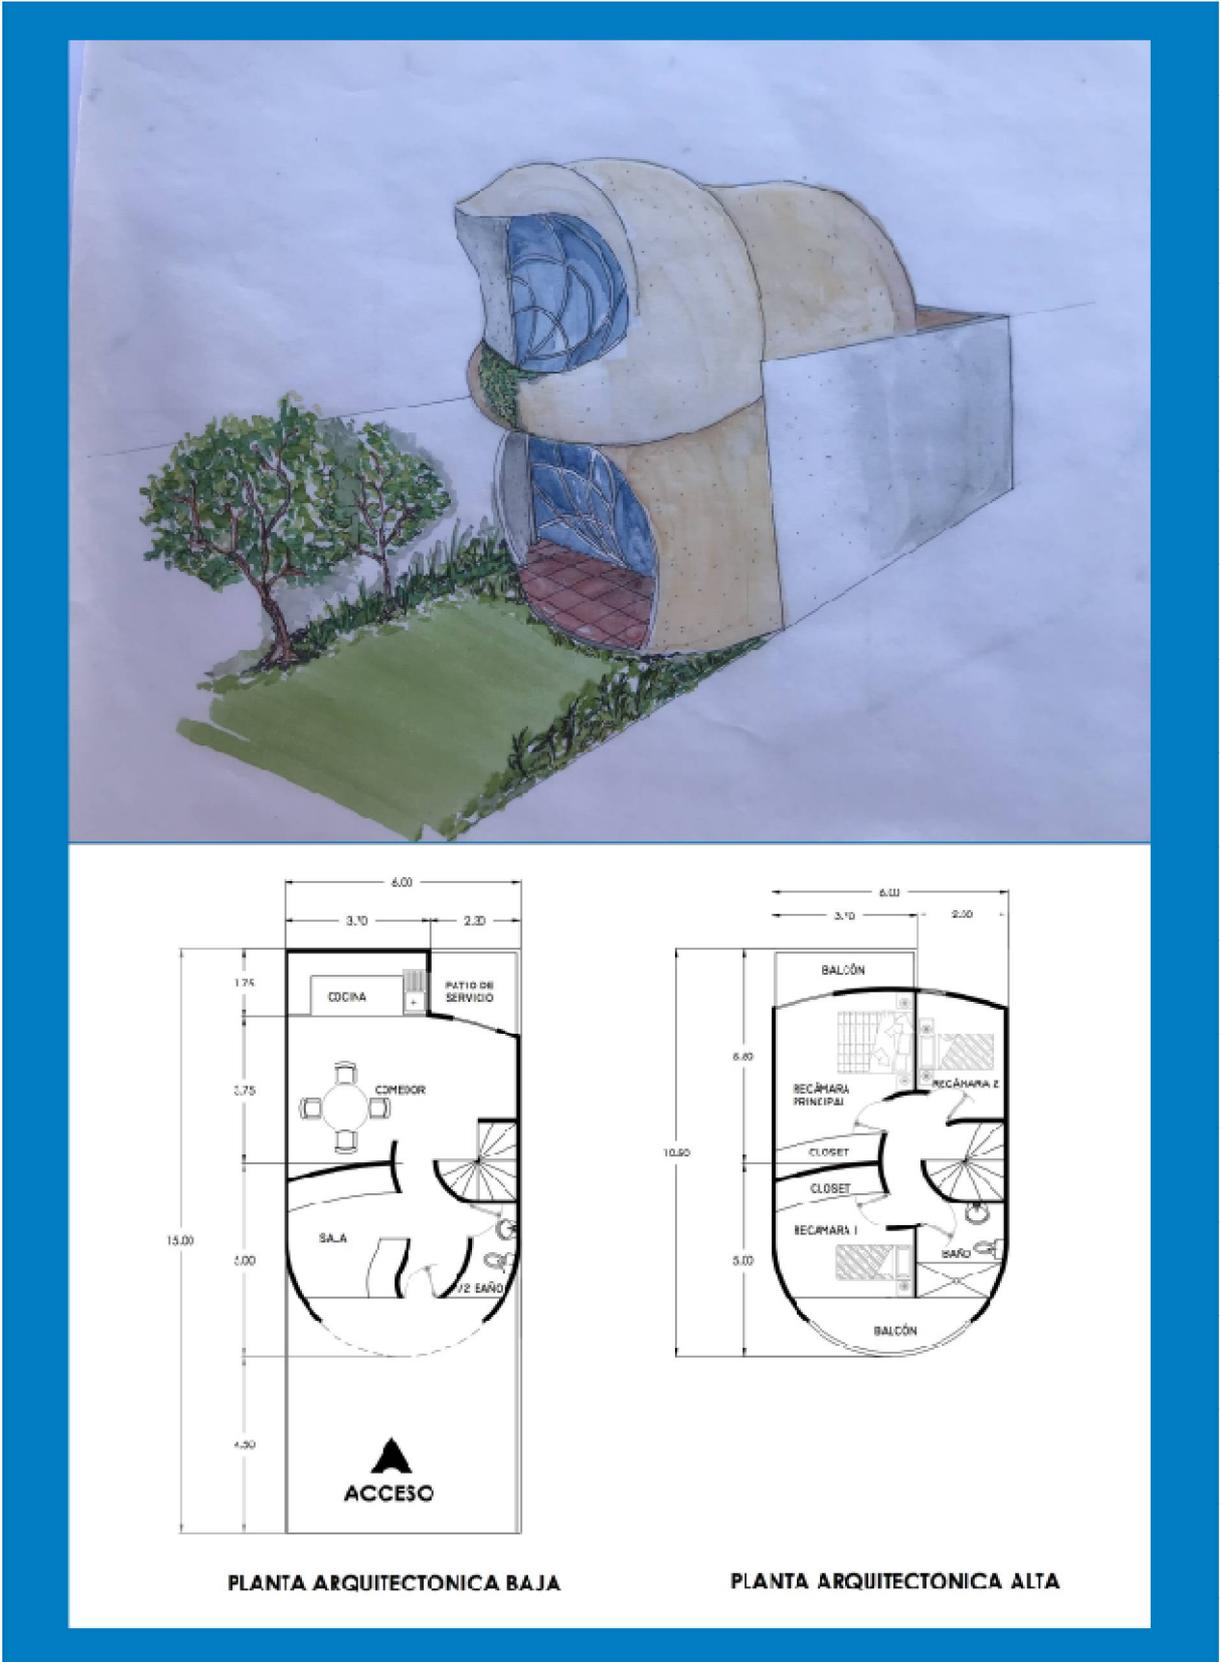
Propuesta 3 – Perspectiva y plantas arquitectónicas-
